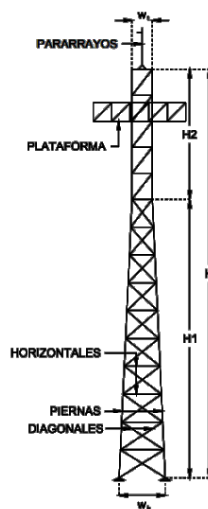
Configuración en elevación de torre con dos secciones transversales.
